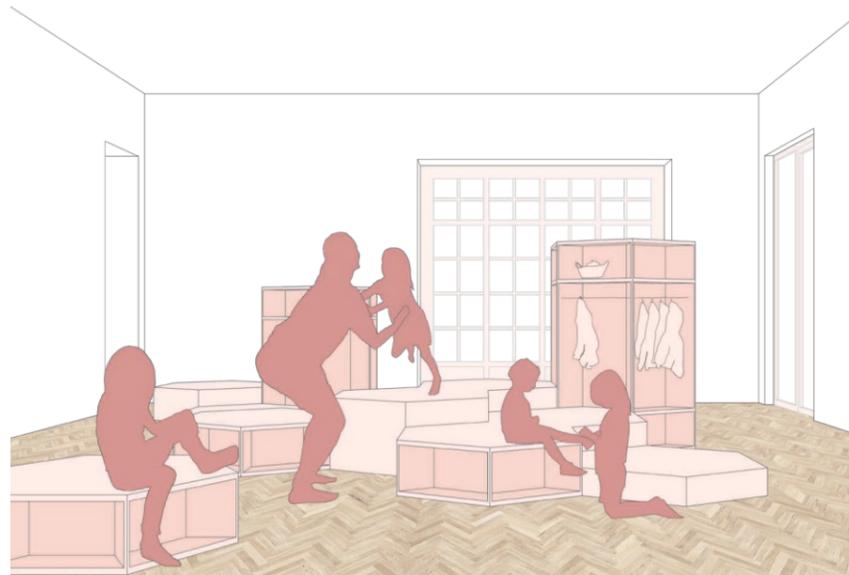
Darstellung Graderobe, Raum 04, Erdgeschoss.
